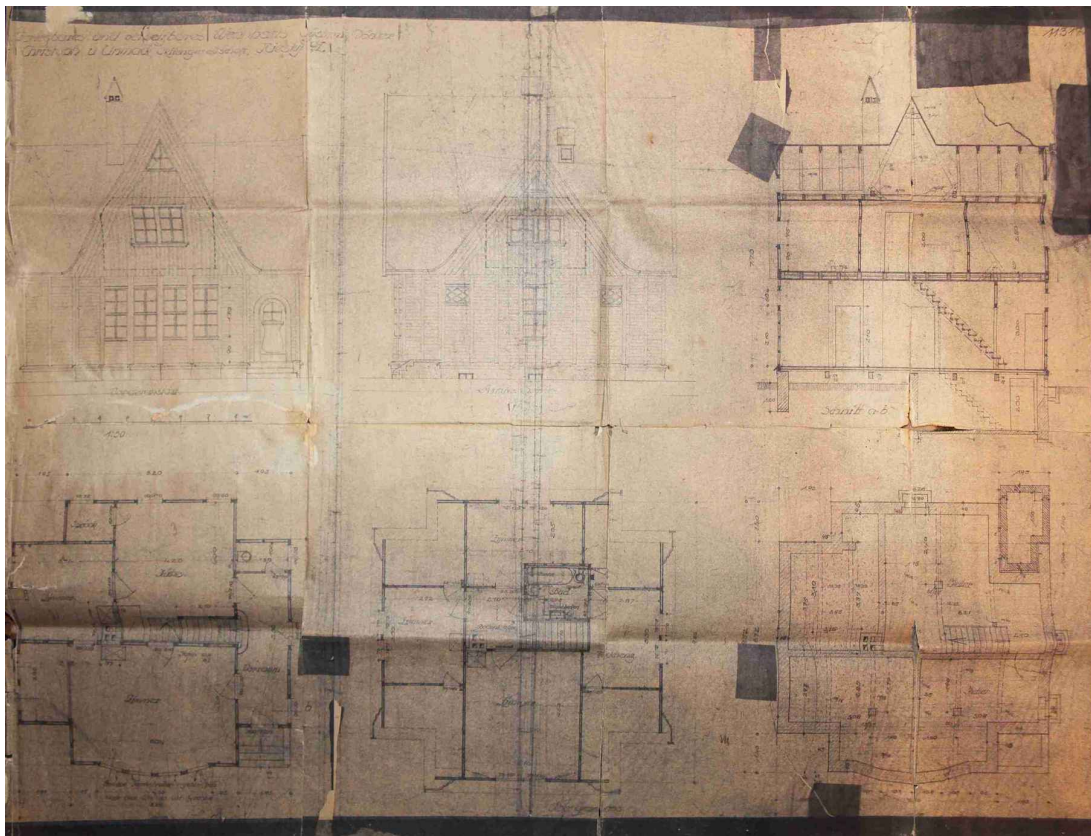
Wohnhaus, Raschkestraße 10 in Niesky. Planunterlage Baugesuch 1922. Grundrisse, Schnitt und Ansichten. Lichtpause. Architekt: Albinmüller. Quelle: Joachim Omonsky, Niesky.
